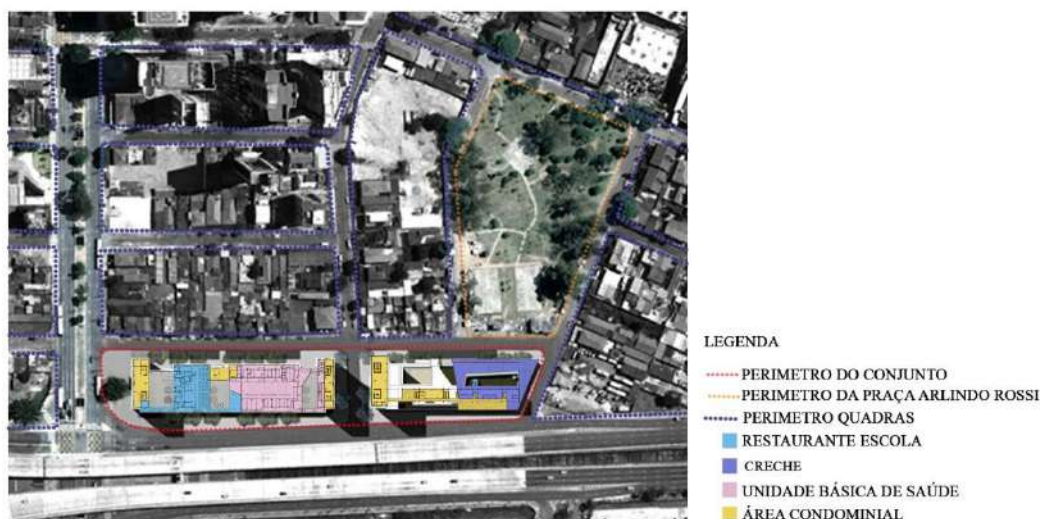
Equipamentos do pavimento térreo do conjunto -
